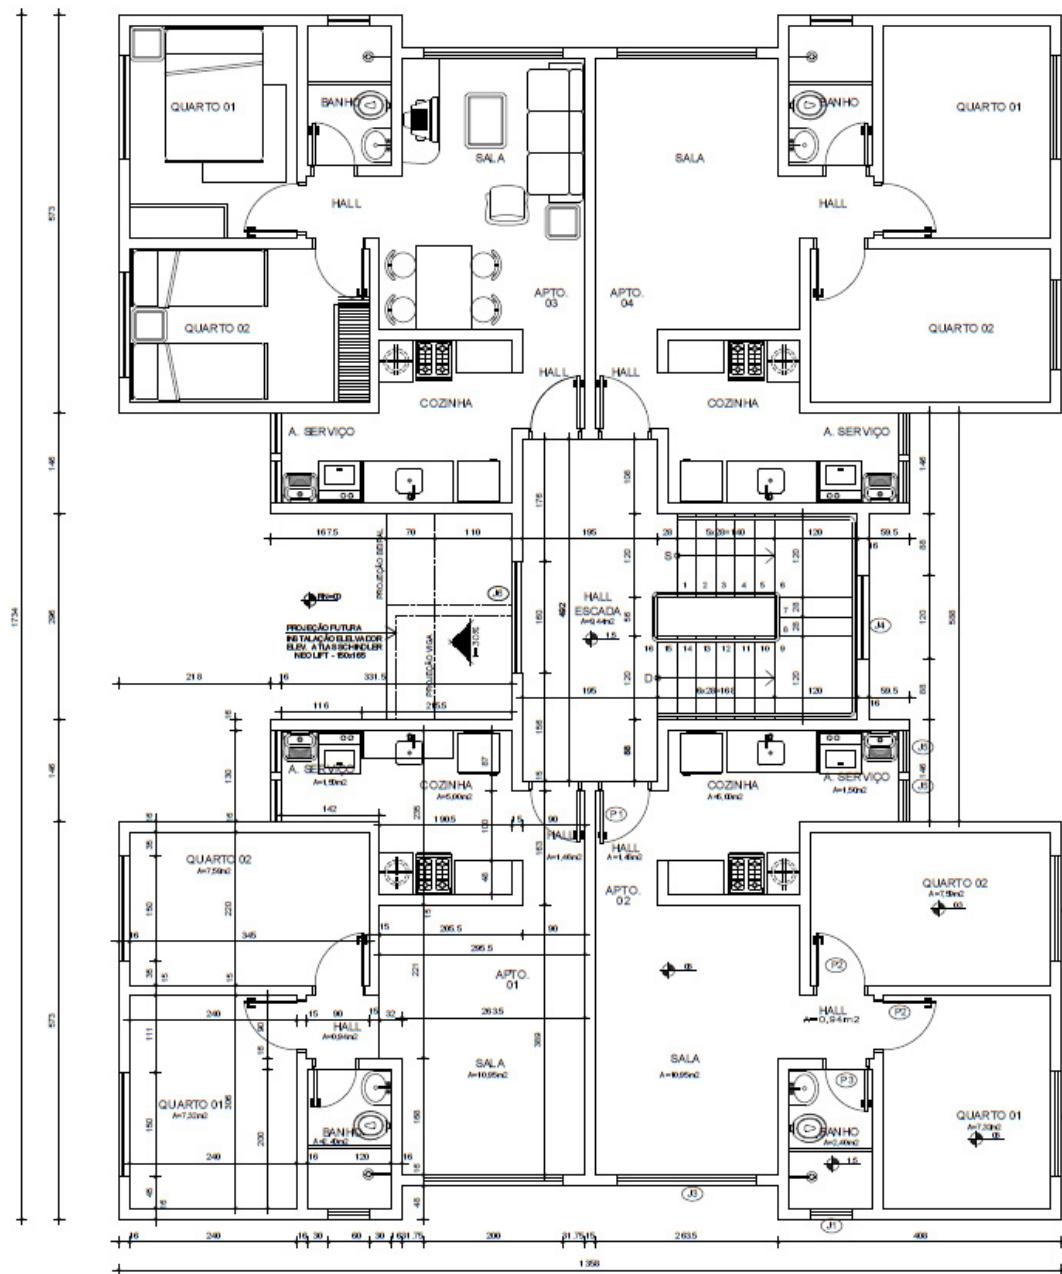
Planta do pavimento tipo de um bloco do Residencial Baltimore. Fonte: Dados obtidos junto à PMU, 2014. Modificado pelos autores.
